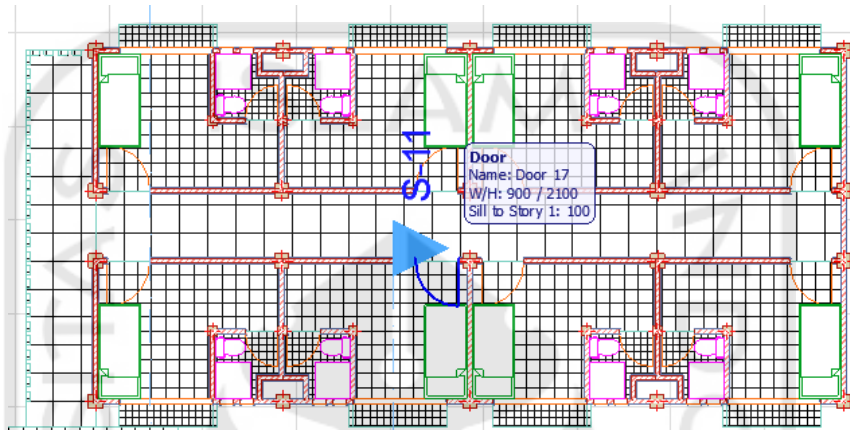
Rancangan Detail Arsitektural Khusus Bangunan 7
